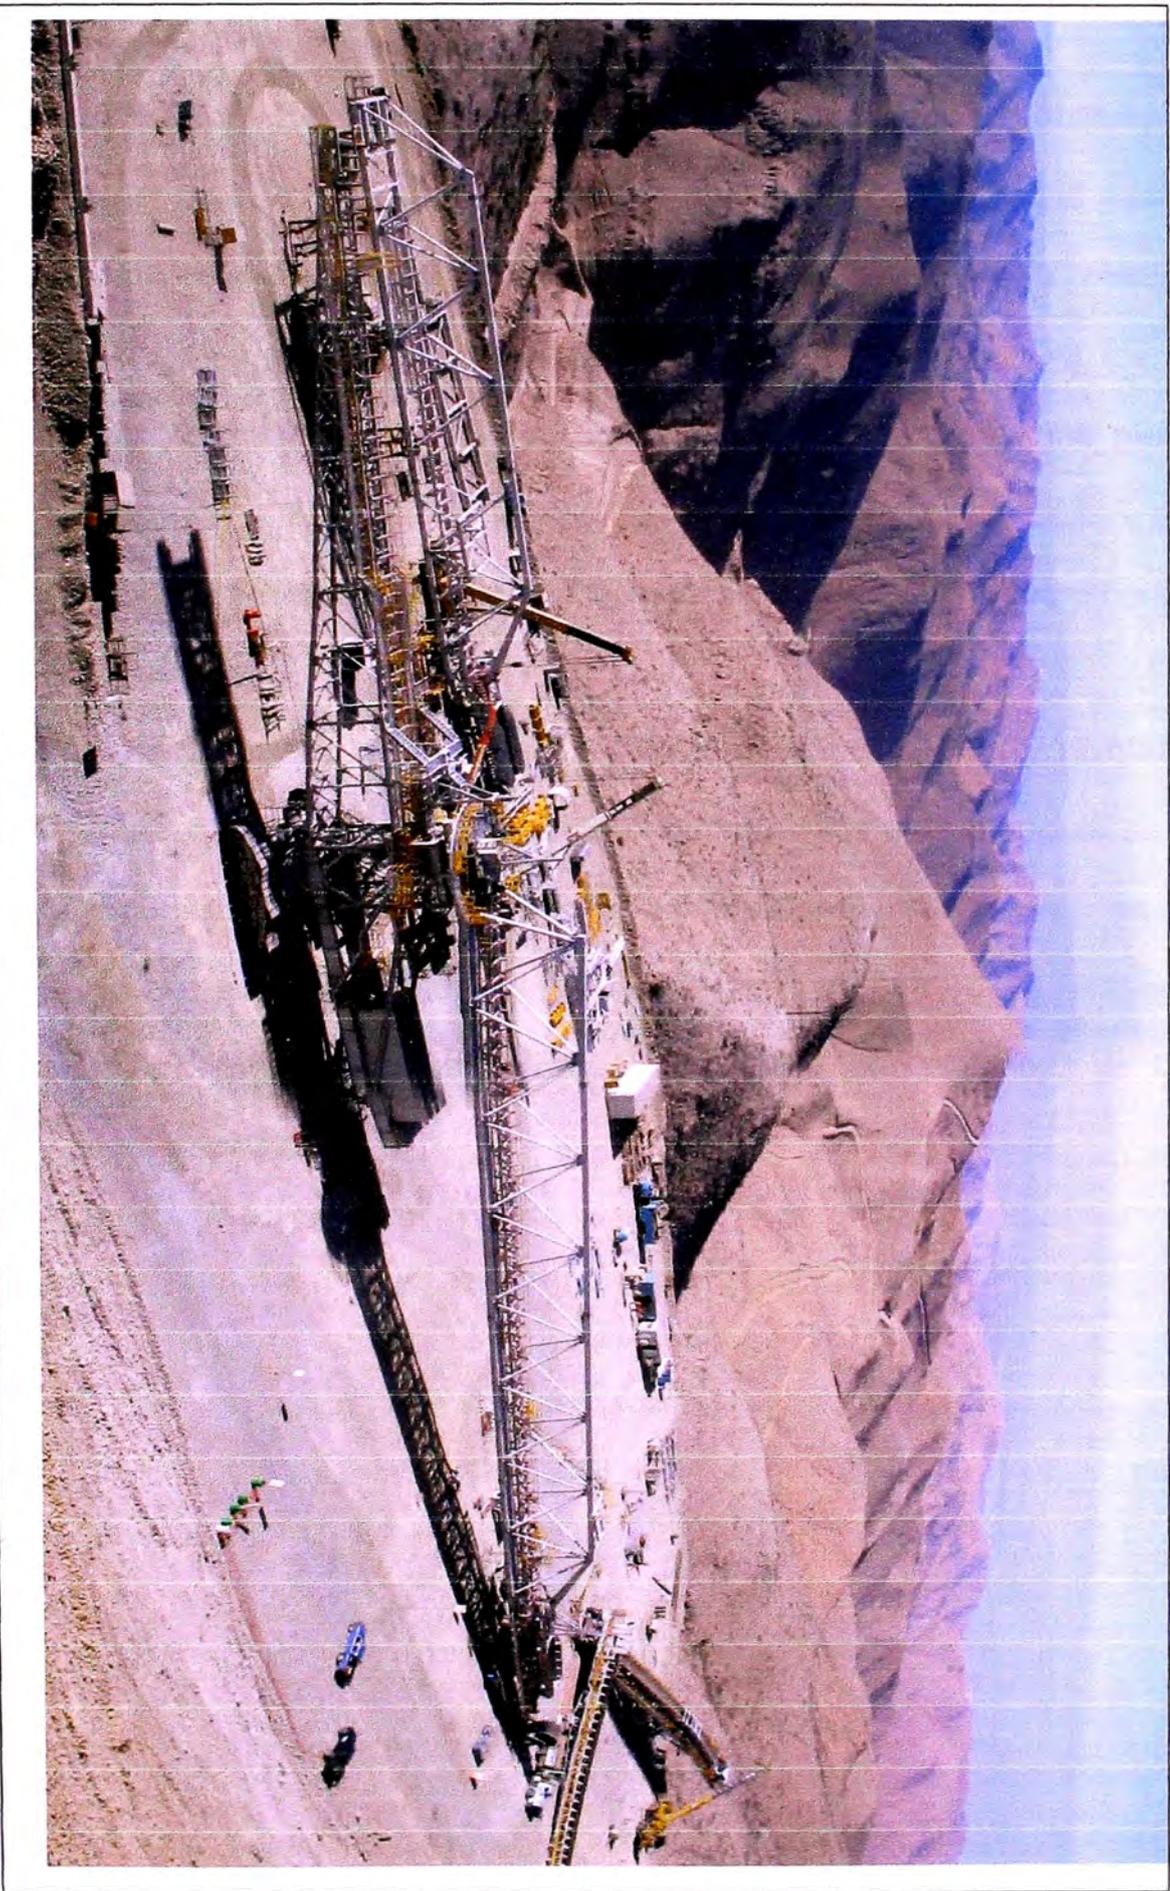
14.- Apilador móvil con estructuras principales montadas
